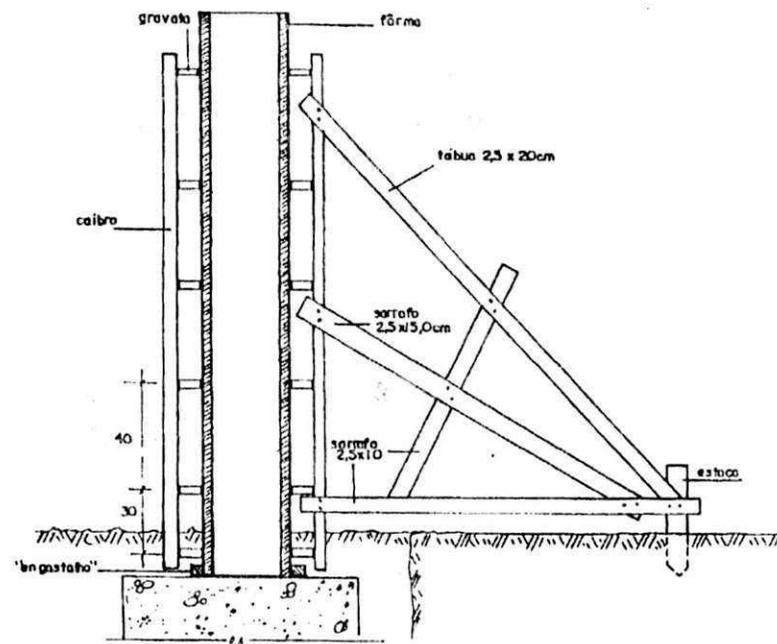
Detalhes do escoramento e contraventamentos em pilares
